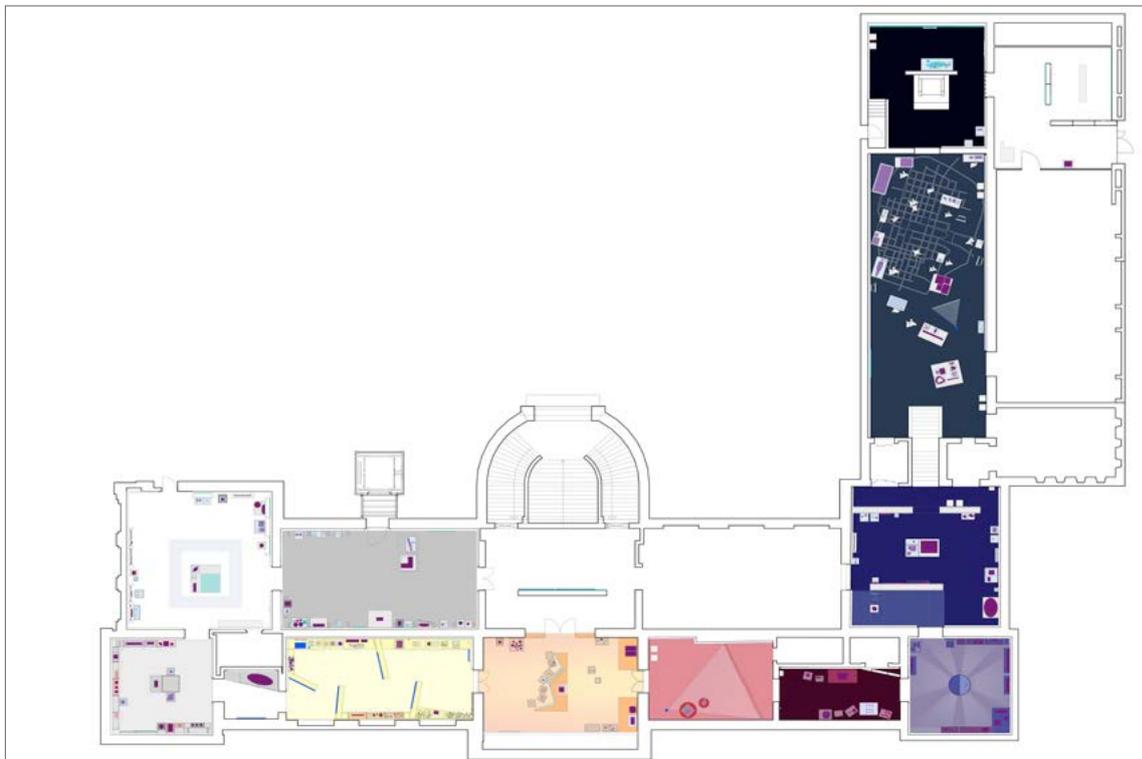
Grundriss der Ausstellung „Der Untergang des Römischen Reiches“.
